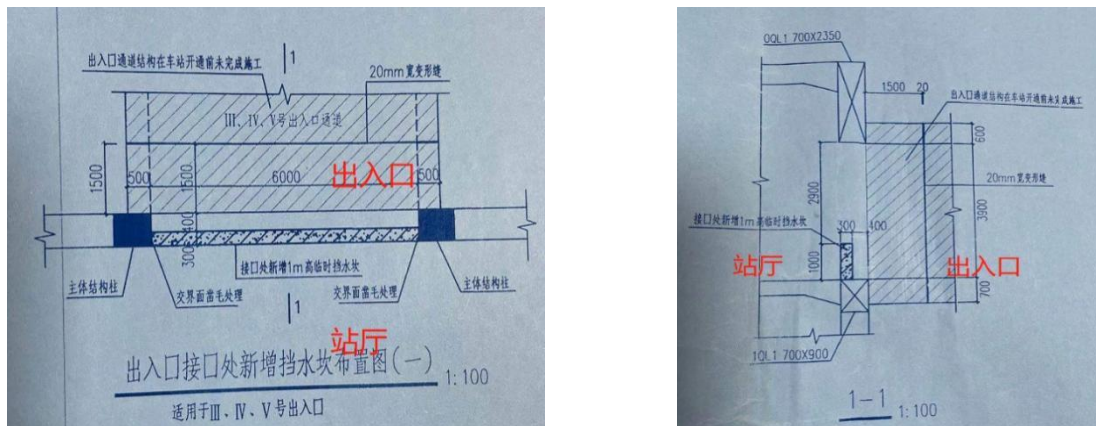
神舟路站站厅与IV号出入口通道位置接口处挡水坎平面图、剖面图
